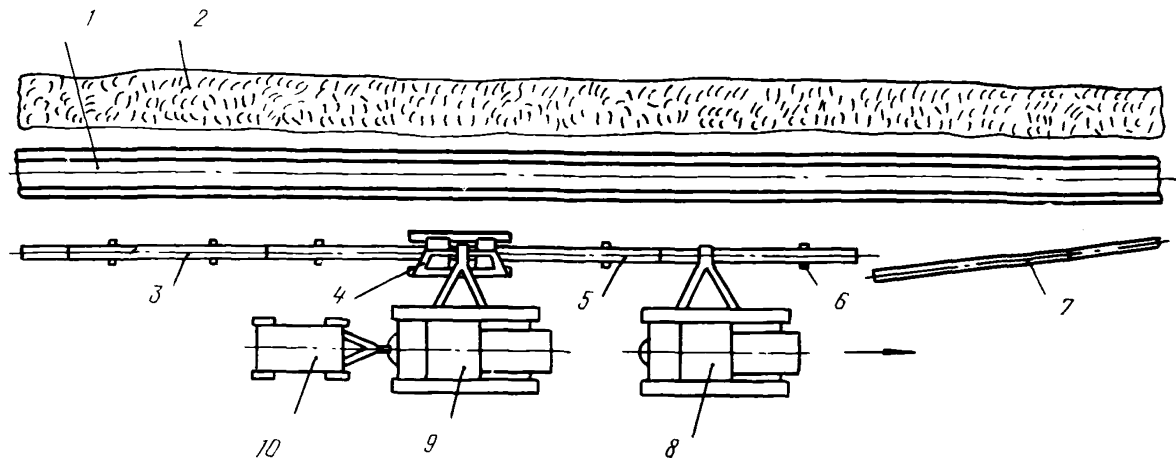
Схема сварки трубопровода в непрерывную нитку с использованием одного центратора и грузоподъемной техники:
